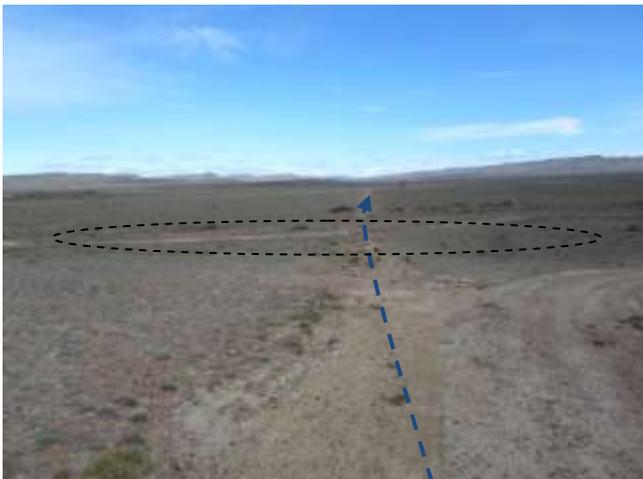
Emplazamiento de acueducto por picada desprovista de vegetación. Cruce con drenaje existente (óvalo negro). Foto en dirección SSO.
